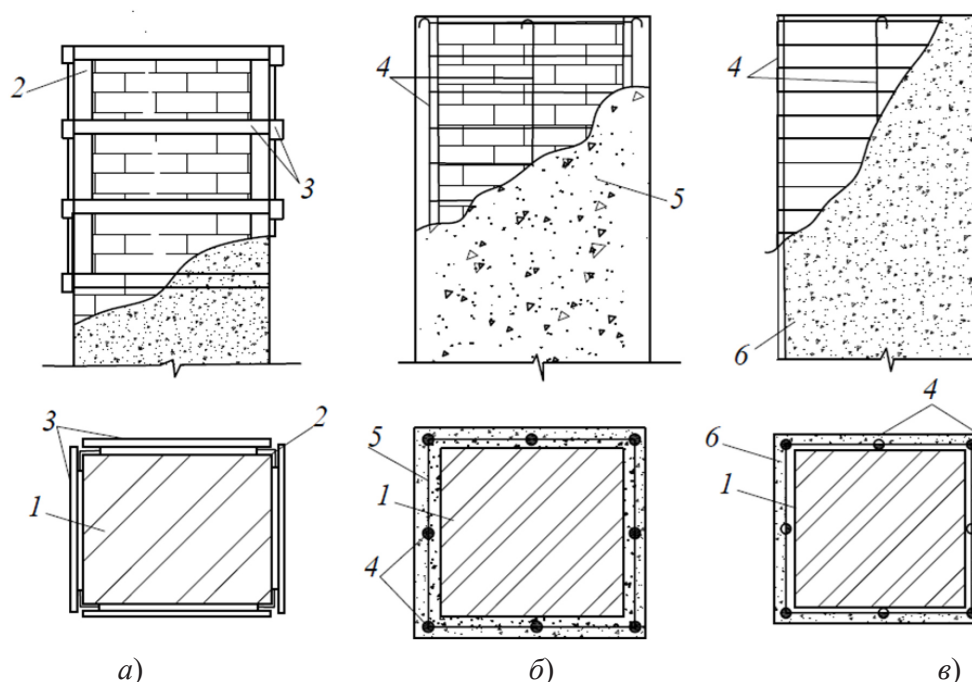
Усиление столбов обоймами: а – металлической; б – железобетонной; в – армированной растворной; 1 – усиливаемый кирпичный столб; 2 – стальной уголок; 3 – стальная планка; 4 – арматурные стержни; 5 – бетон обоймы; 6 – раствор обоймы
